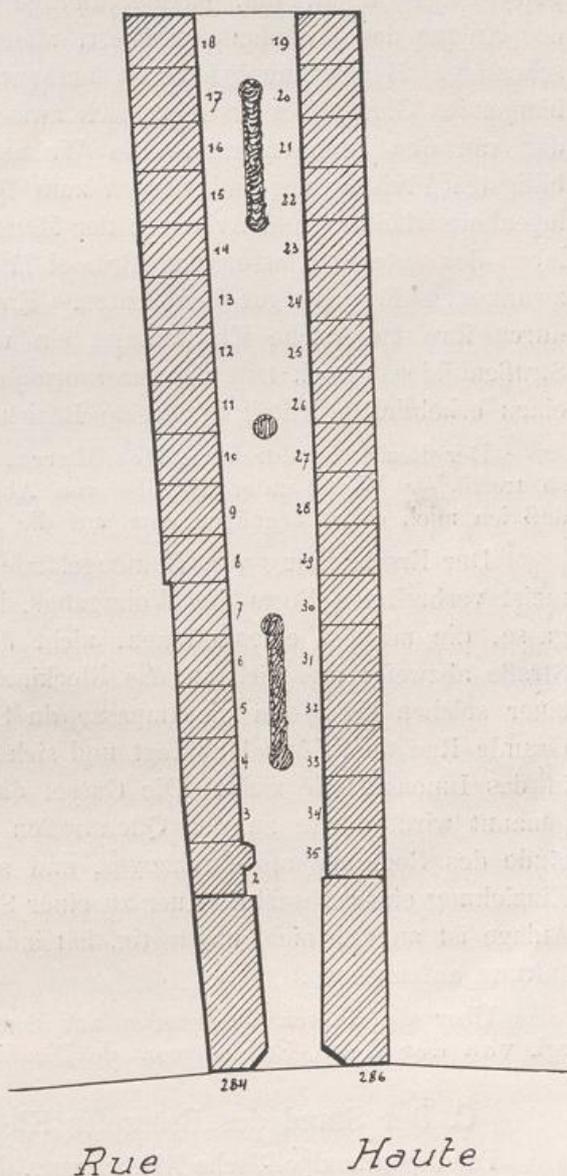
Impasse Defuisseaux, Grundriß. Maßst. 1:650.
